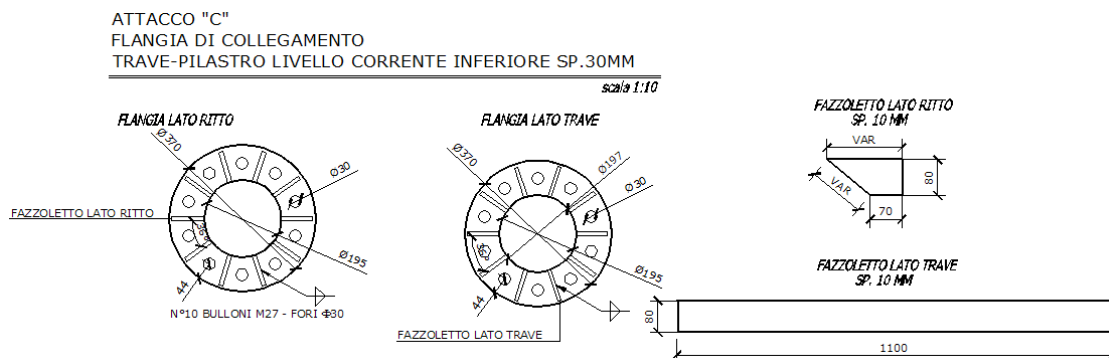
Collegamenti bullonati per le giunzioni flangiate dei correnti orizzontali della traversa a sbalzo.
